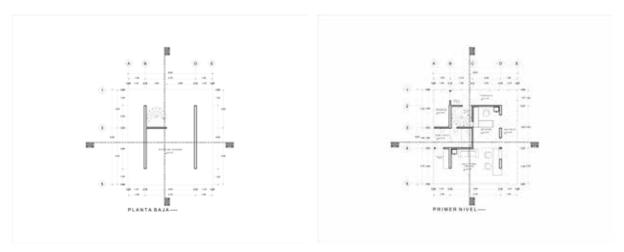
Planta baja y Primer nivel del proyecto de una Caseta de Vigilancia en la UAM Azcapotzalco
